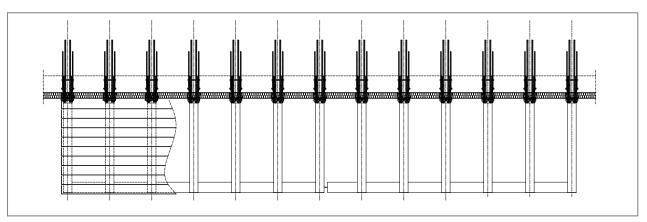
Schöck Isokorb® T type SK: Balcony freely cantilevered
